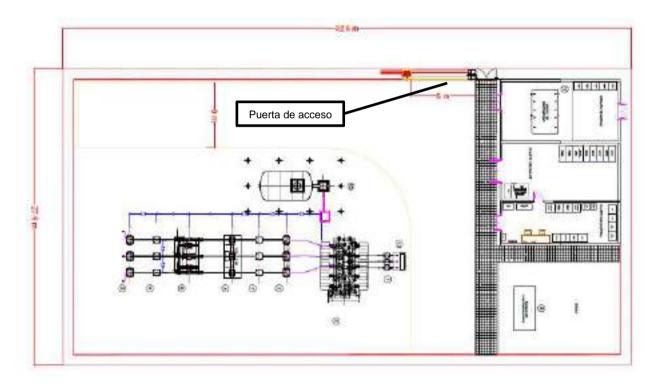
Puerta de Acceso a la Subestación Elevadora.
